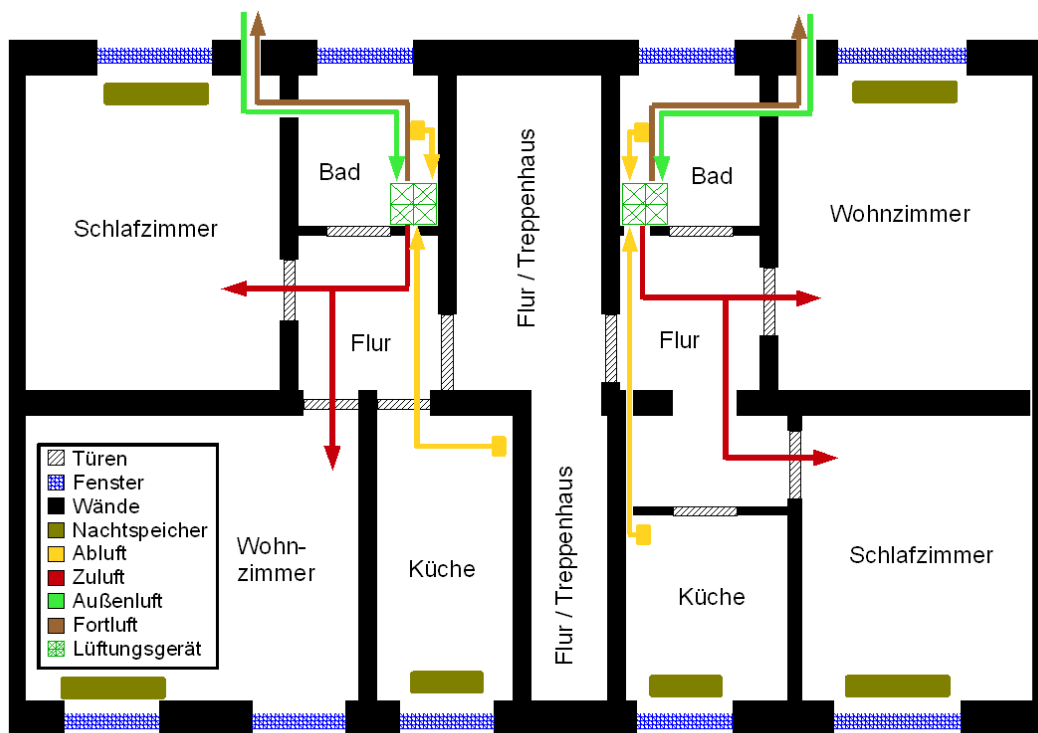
Beispielhafter Grundriss mit prinzipiellen Aufbau der Lüftungsanlage
